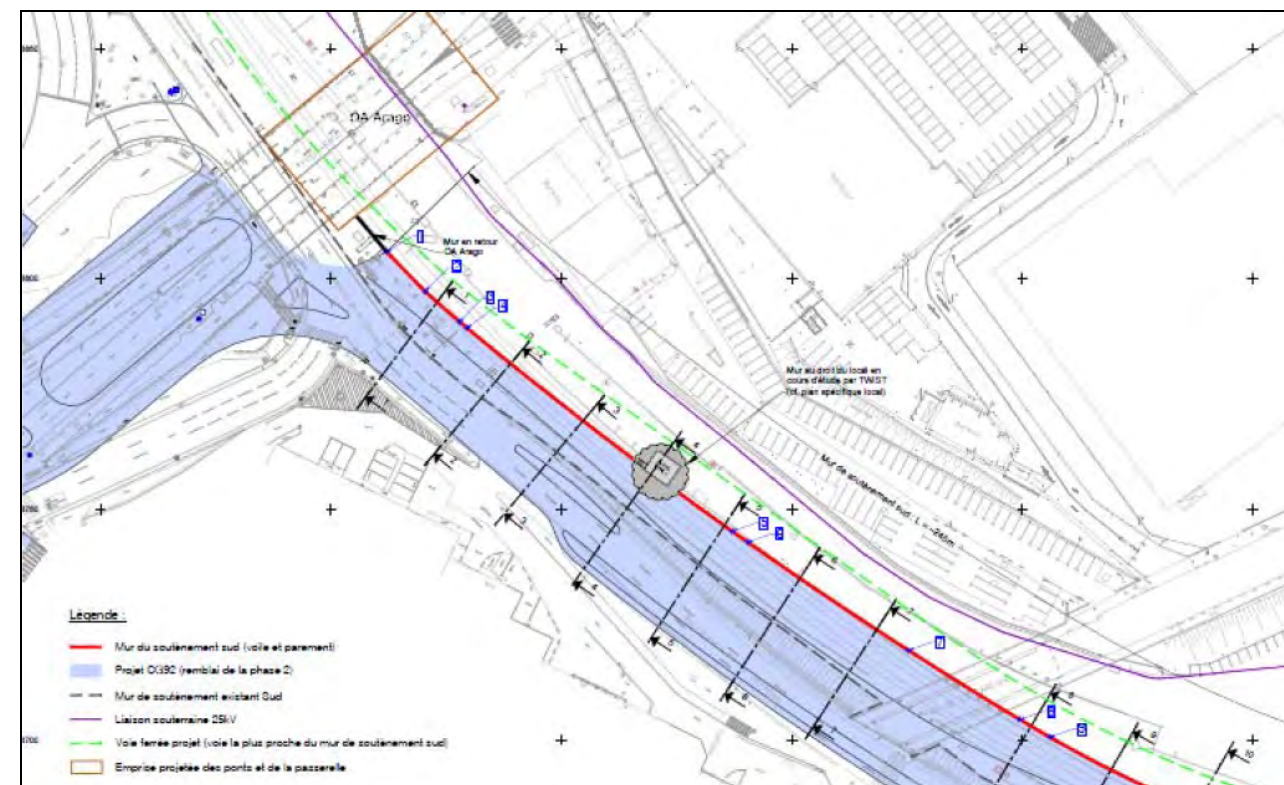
Implantation du mur de soutènement SUD du faisceau entre Arago et Hébert
